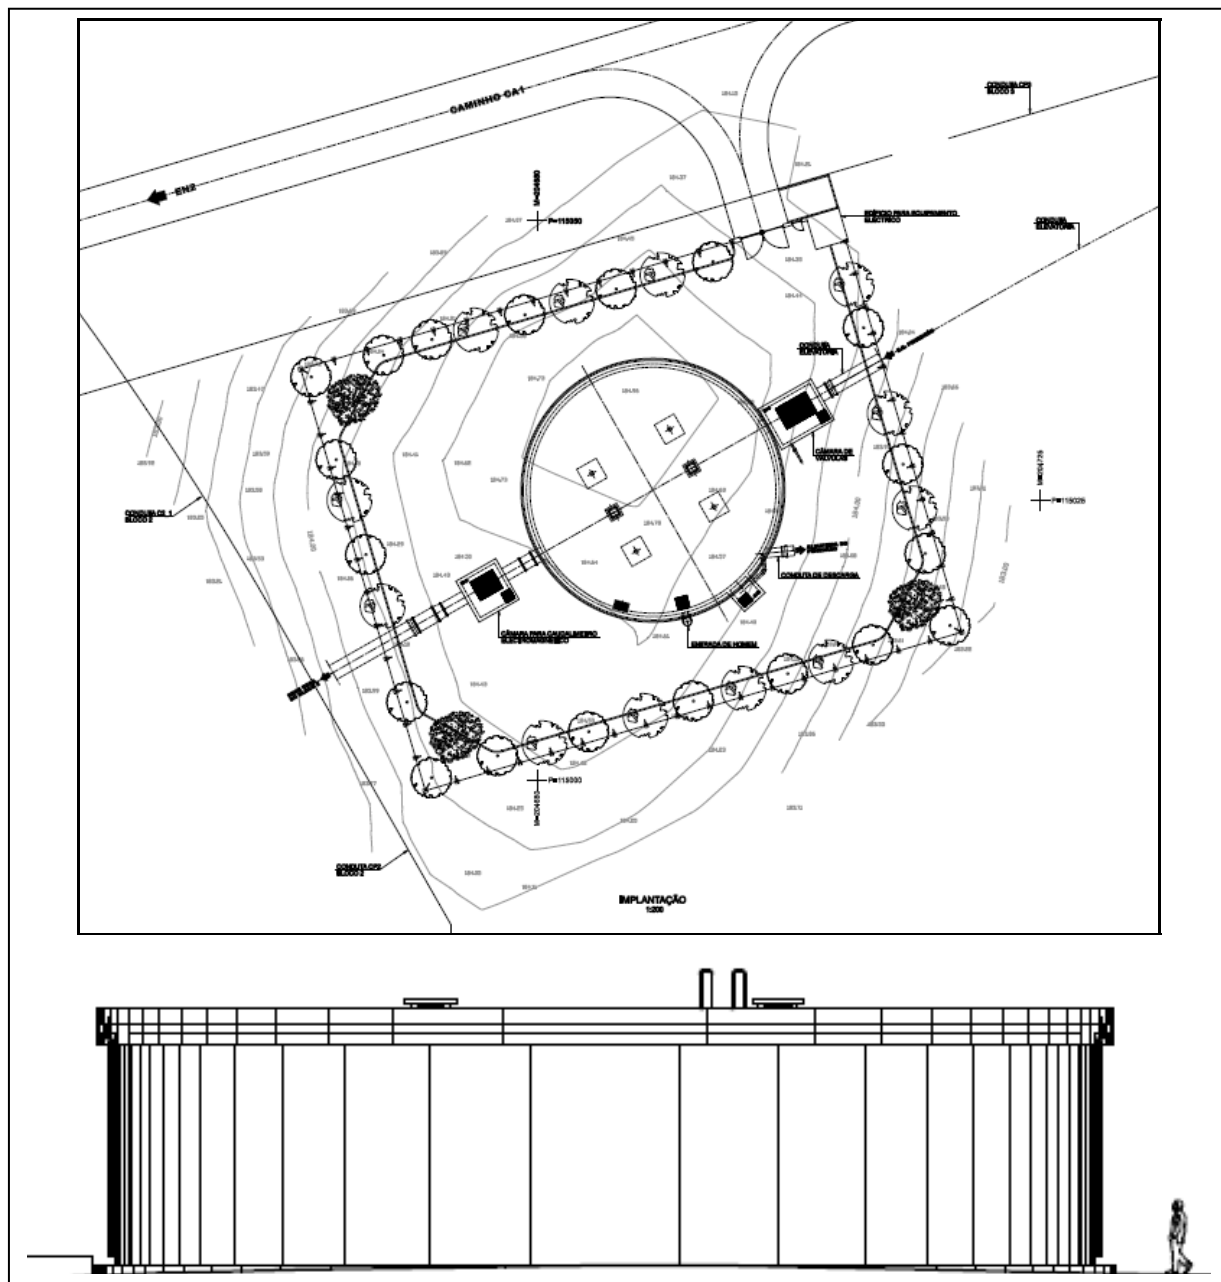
Planta de implantação em cima e alçado do reservatório R2 em baixo.
